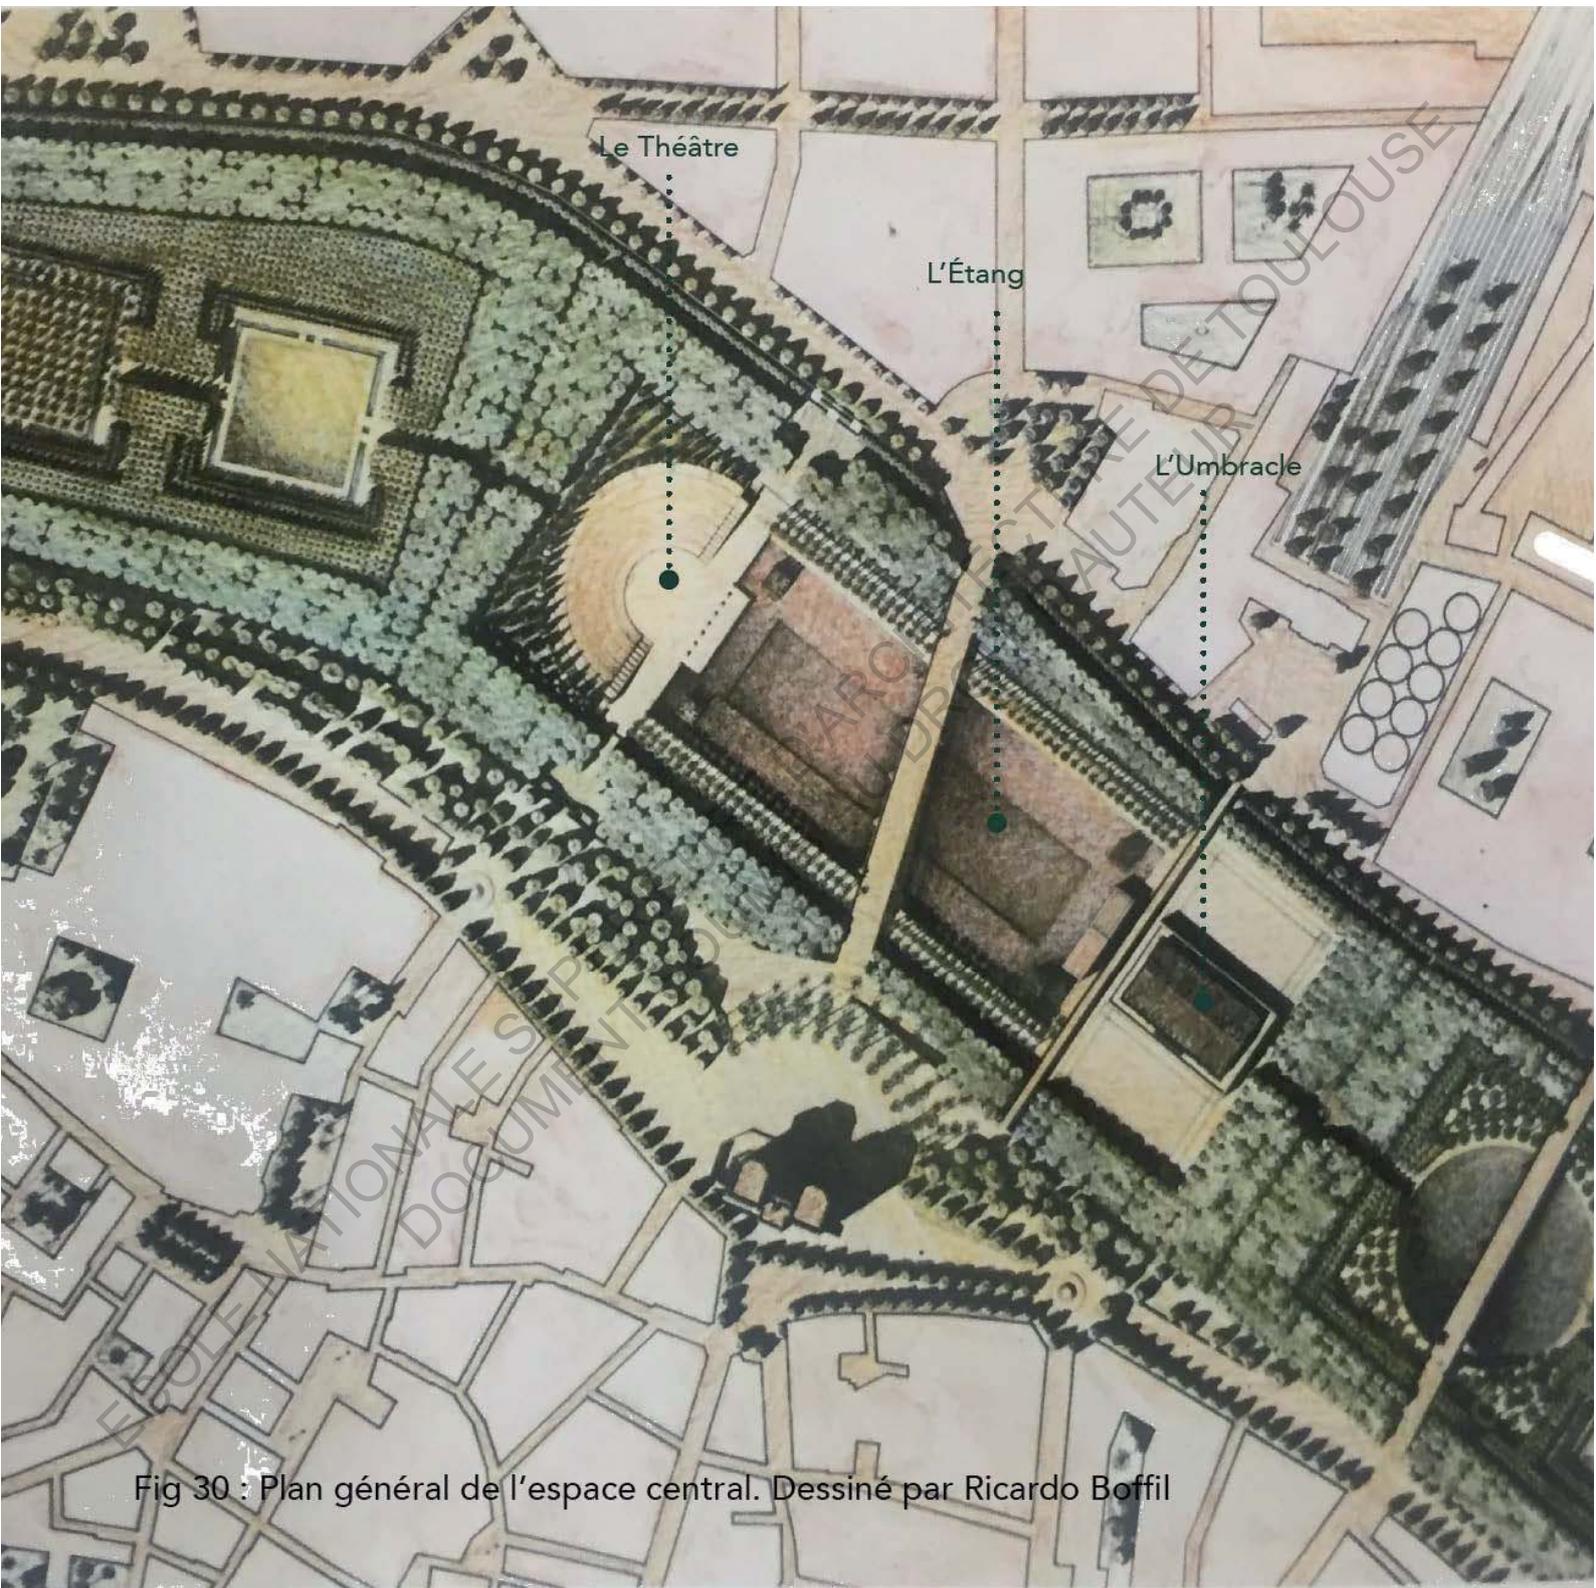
Plan général de l'espace central. Dessiné par Ricardo Boffil
